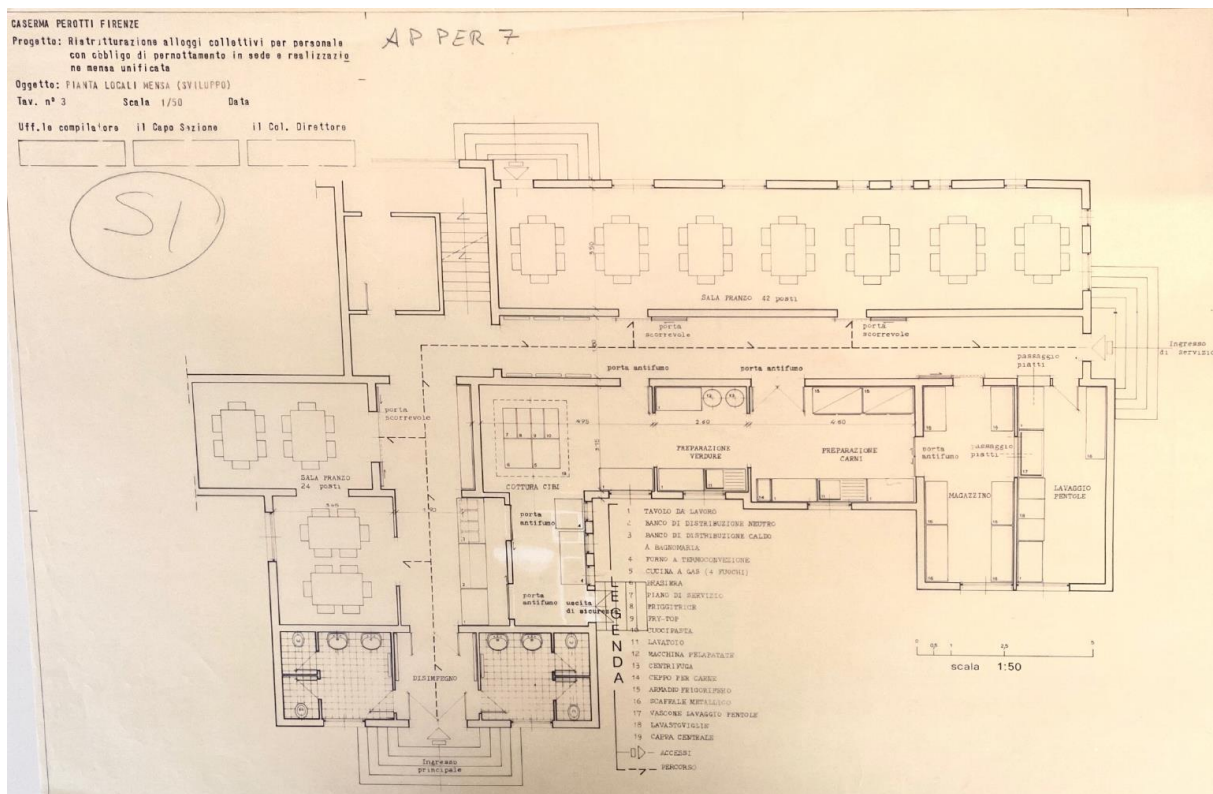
Pianta piano terra - distribuzione con funzione di mensa - progetto.
